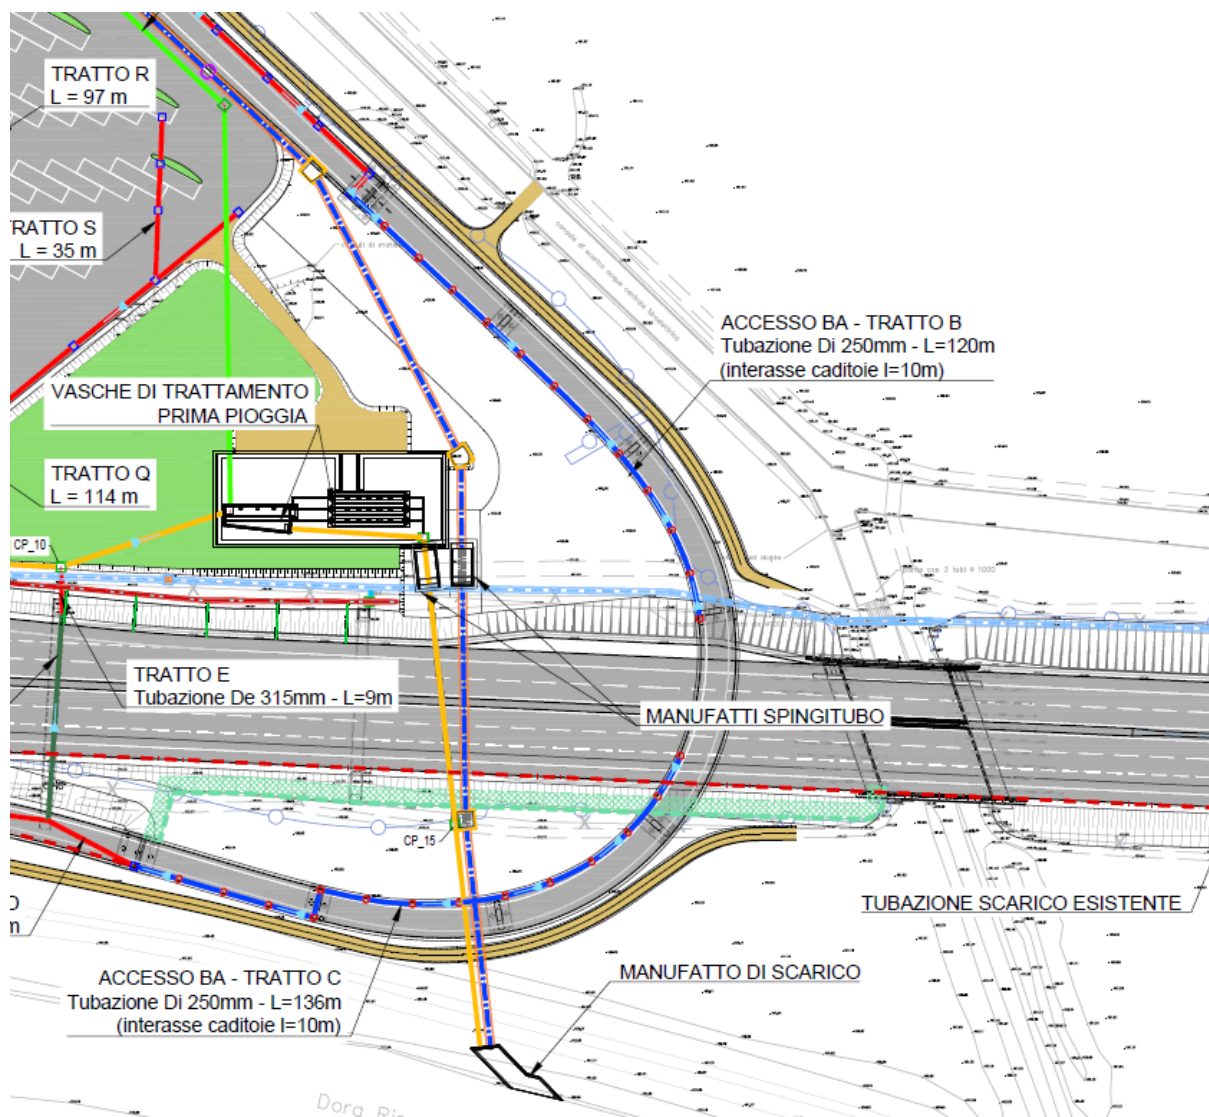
planimetria di inquadramento del manufatto scaricatore
